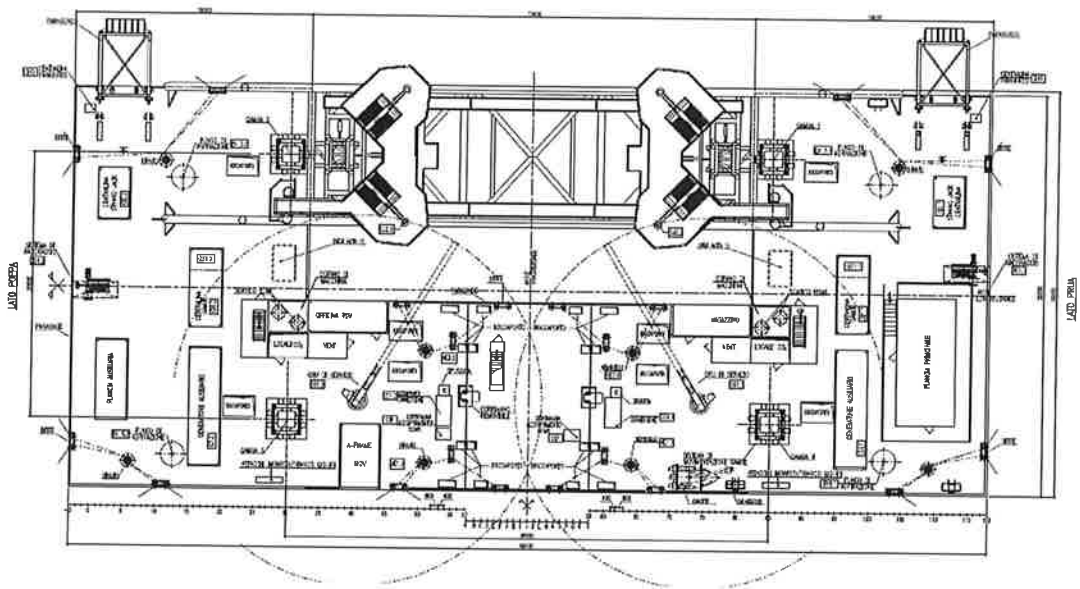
JACK-UP – PIANTA COPERTA
